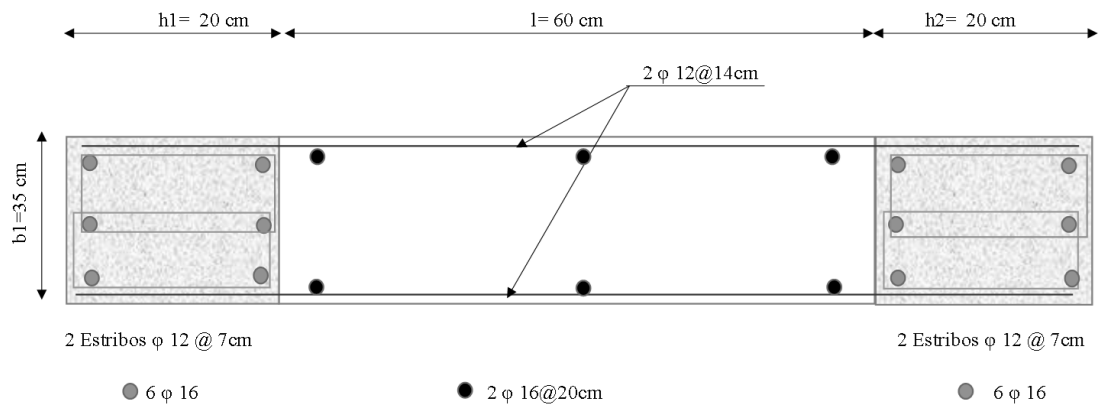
Armado del muro correspondiente a la geometría 2 en base al DDBD
